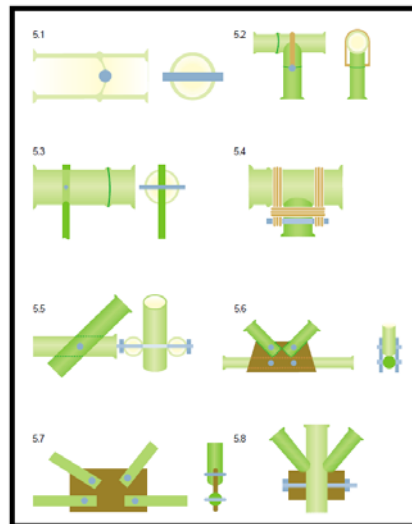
Unión de Sección Transversal a un Elemento Paralelo
